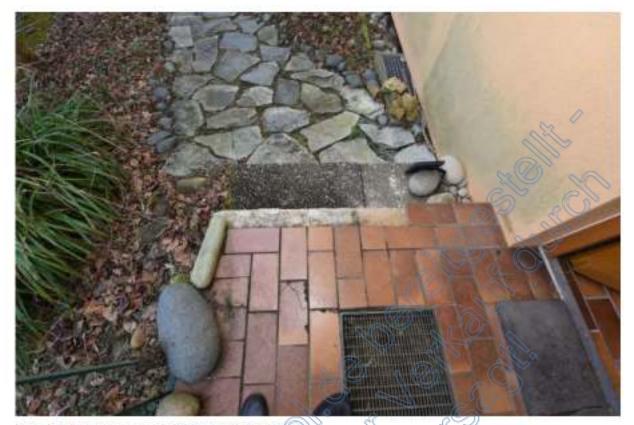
Hauseingang, beschädigter Klinkerbelag
